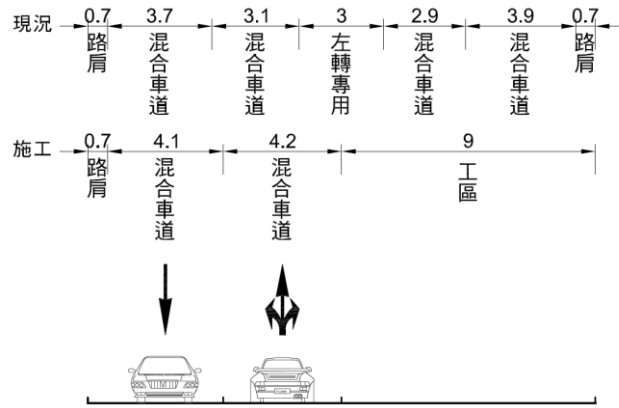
民族路 RCP 管施工斷面配置示意圖
